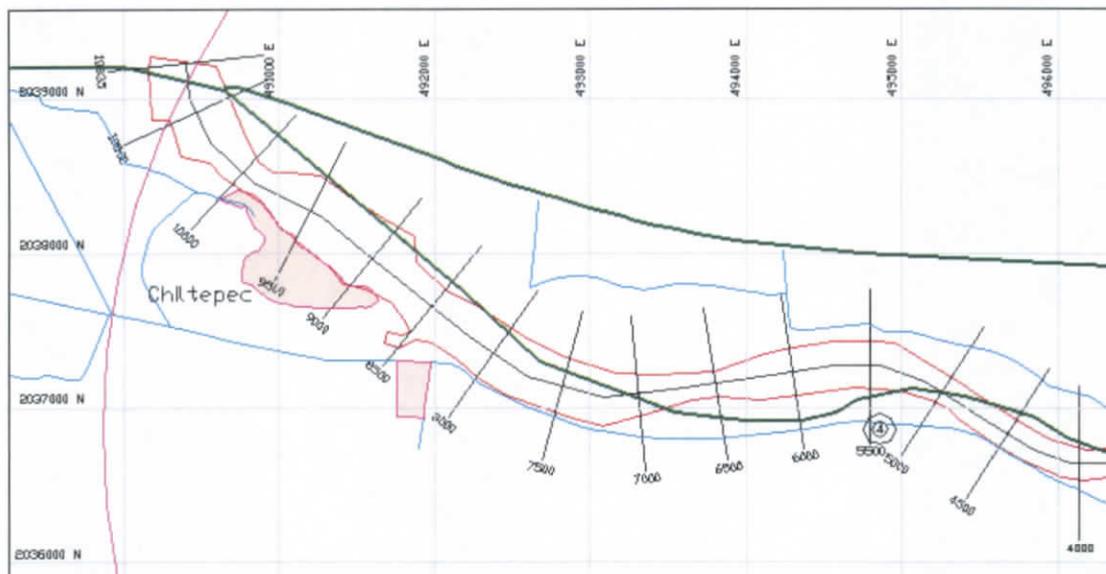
Plano guía del levantamiento del río González (IINGEN, 2014)
